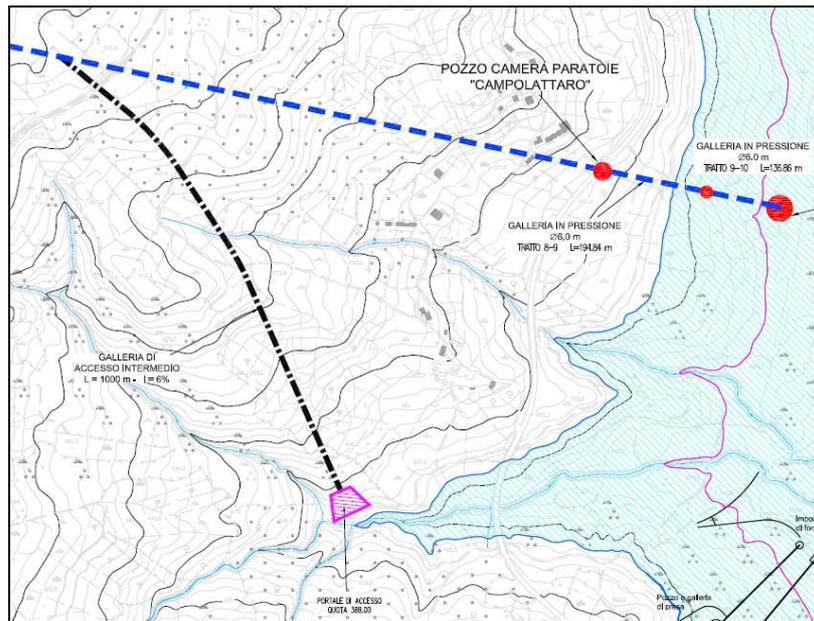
stralcio planimetrico tracciato galleria di accesso sup. al pozzo piezometrico di valle
